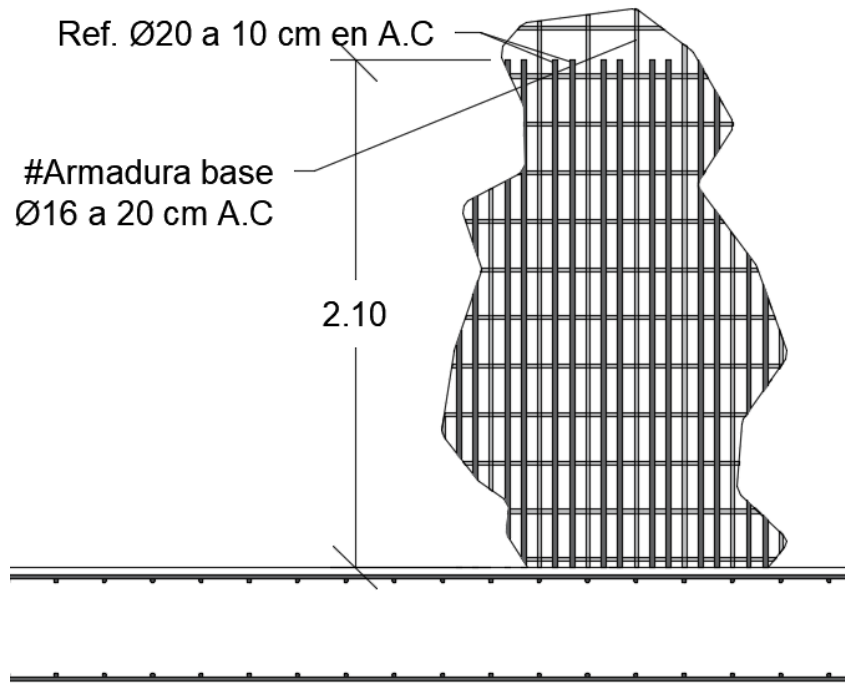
Refuerzo en muro interno 3 centro (armadura horizontal)
